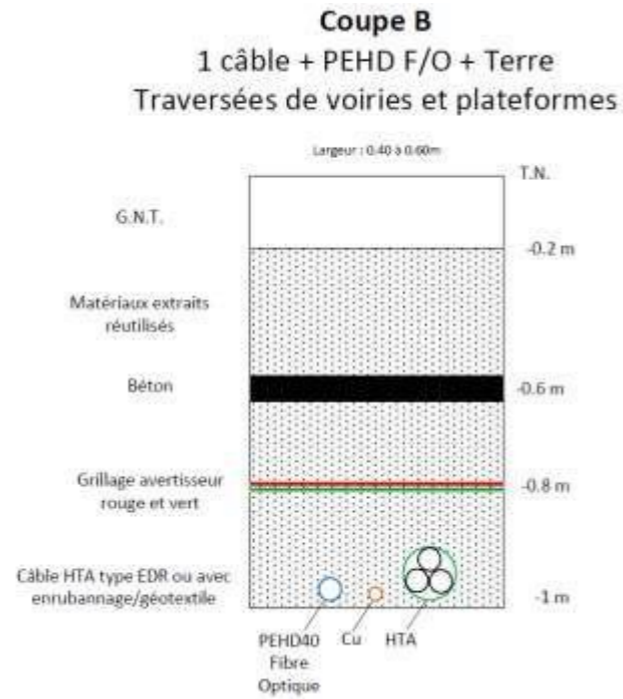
Coupe type de tranchées pour traversées de voiries et plateformes
